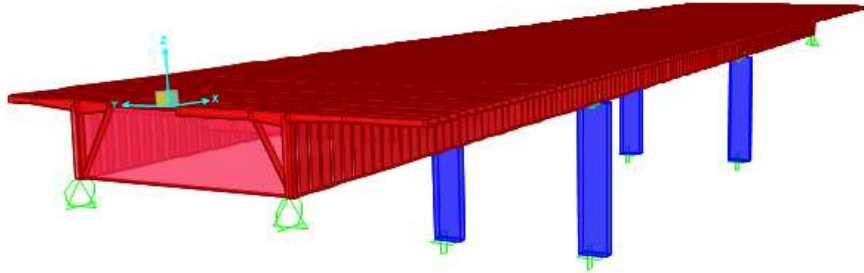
Vista 3D da estrutura modelada (acervo do autor)
